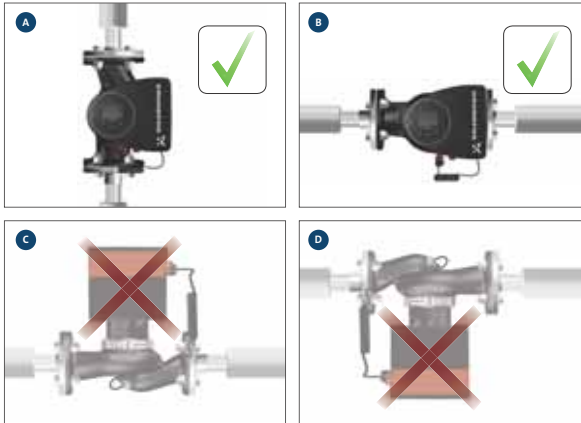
Eingebaute Pumpe mit Motorwelle in horizontaler Position
